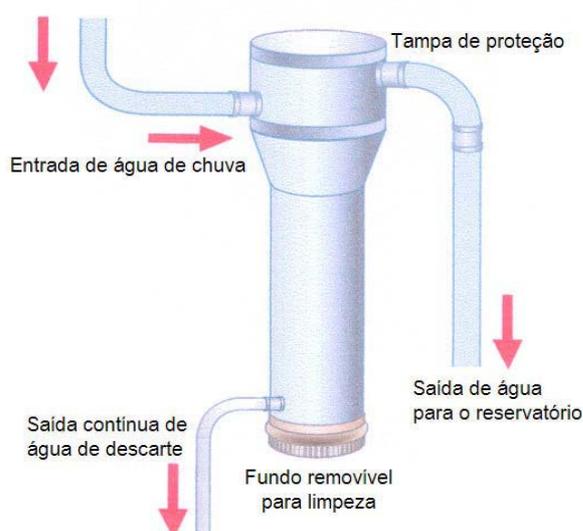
Dispositivo de descarte da água de limpeza de telhado utilizado na Austrália
